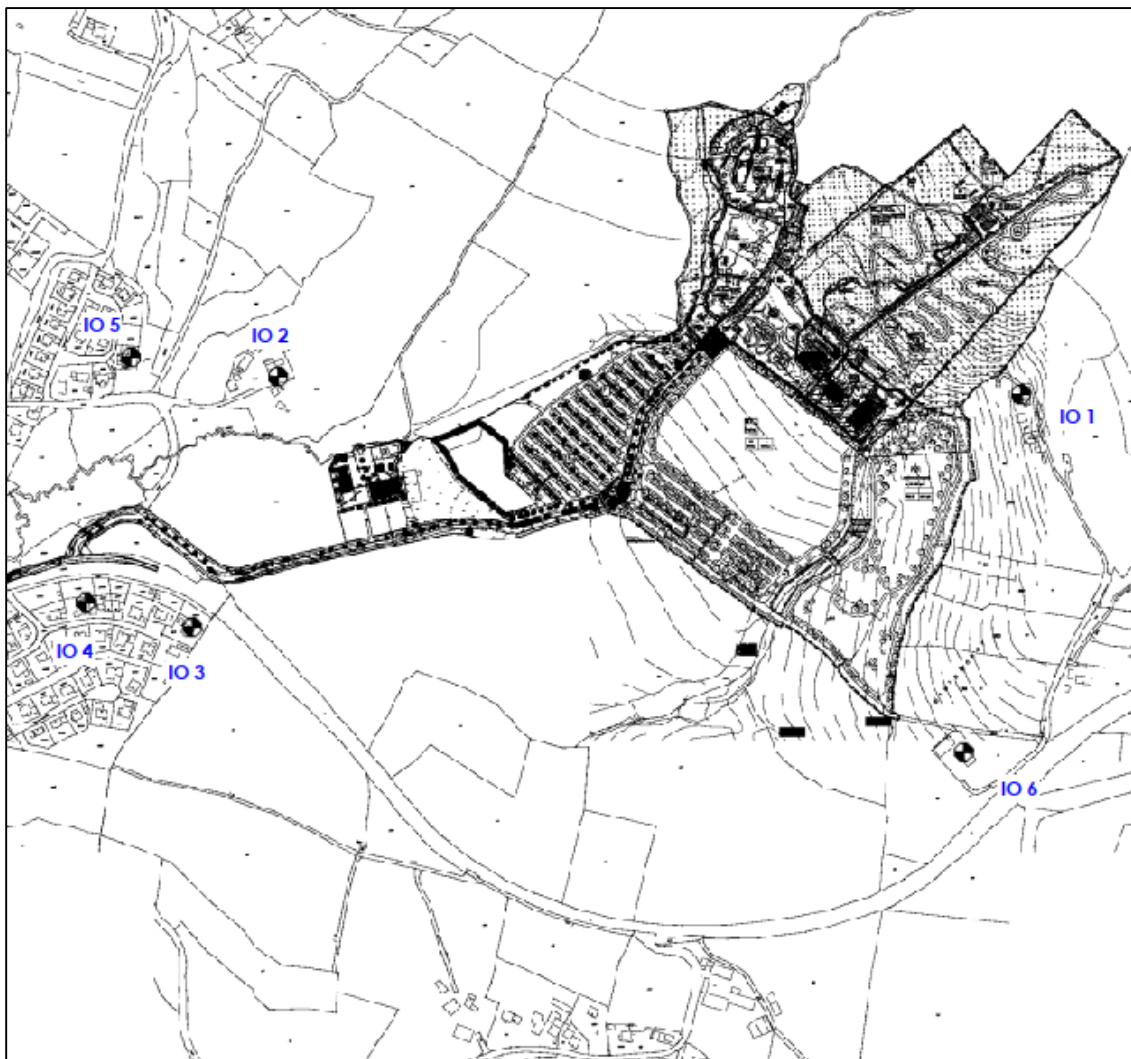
Lageplan mit Darstellung der maßgeblichen Immissionsorte
